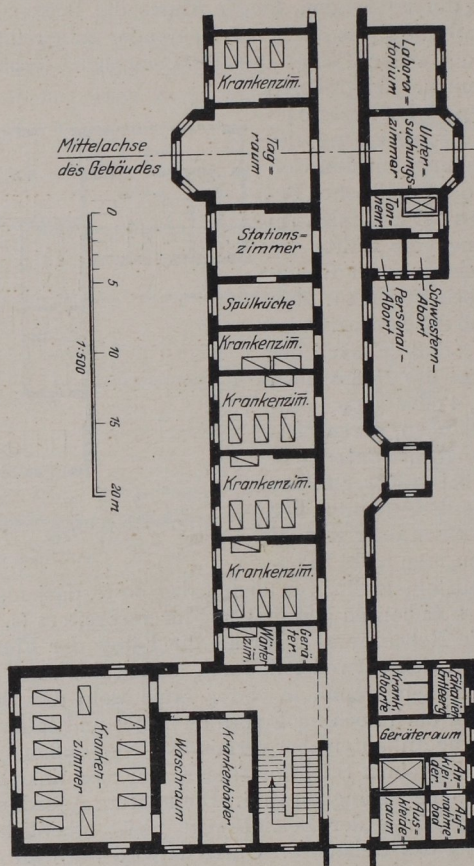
München-Schwabing, städt. Krankenhaus, Bettenhaus.
